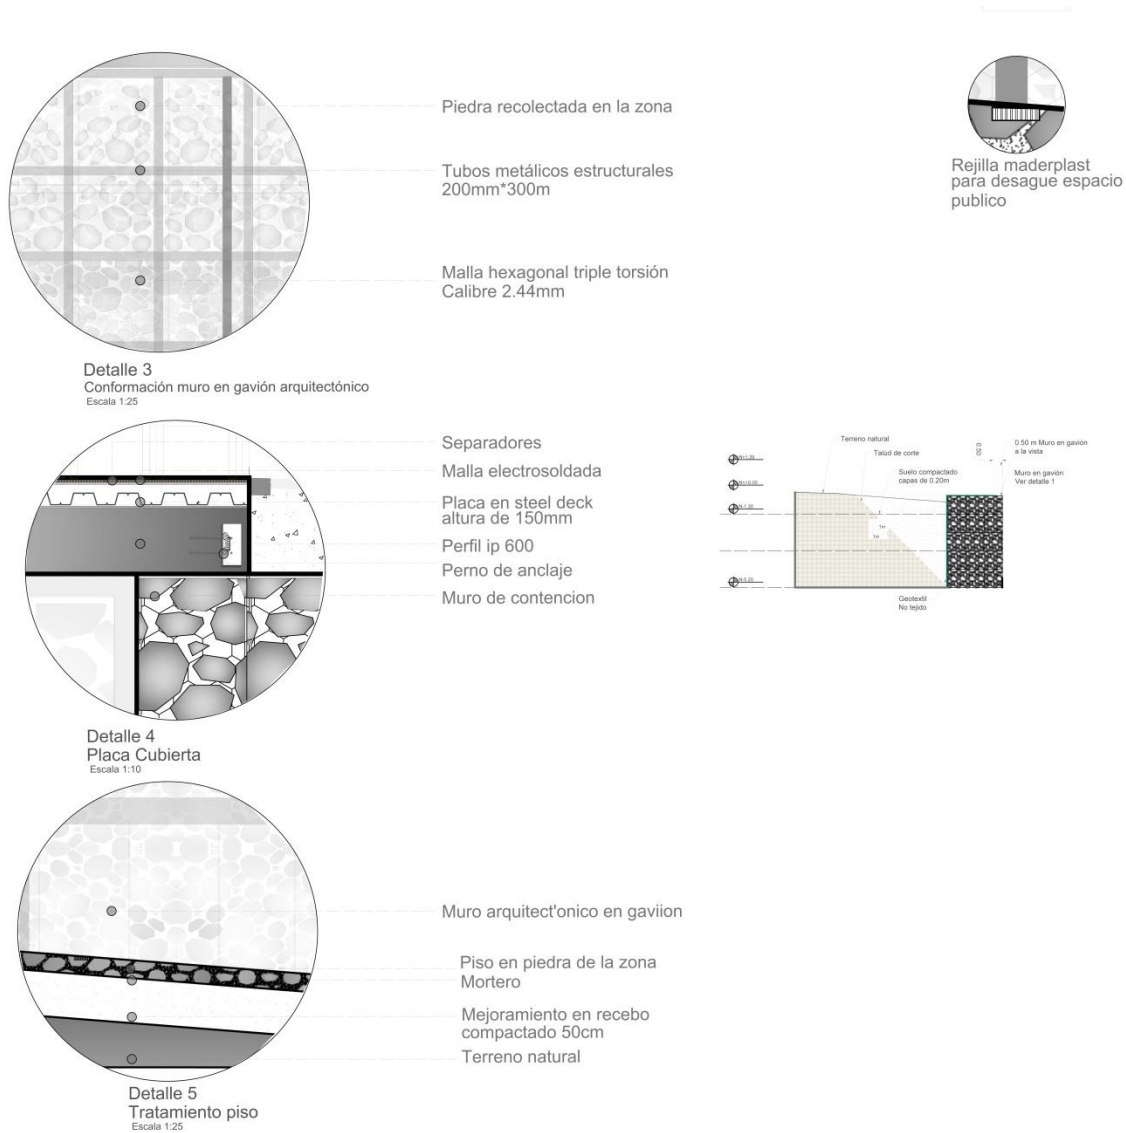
Detalles constructivos, equipamiento pedagógico. Fuente: Paola Caballero
